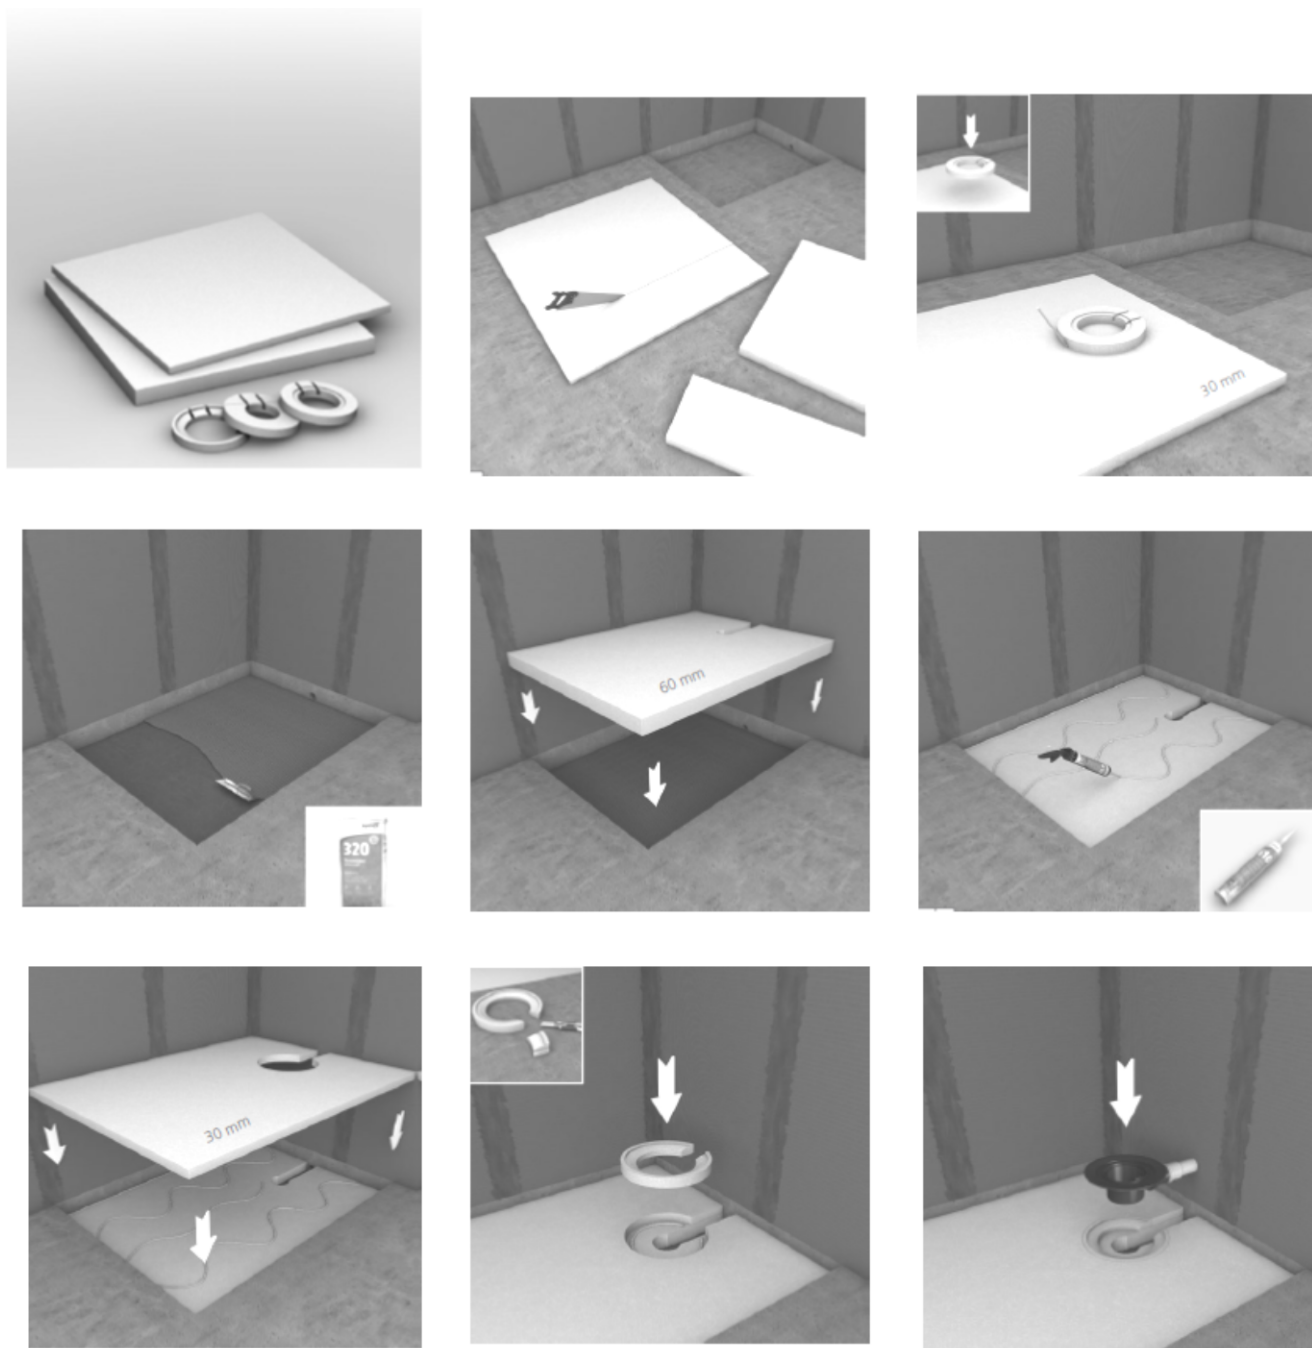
Montage de la rehausse KIT DE REHAUSSE FUNDO en rénovation
